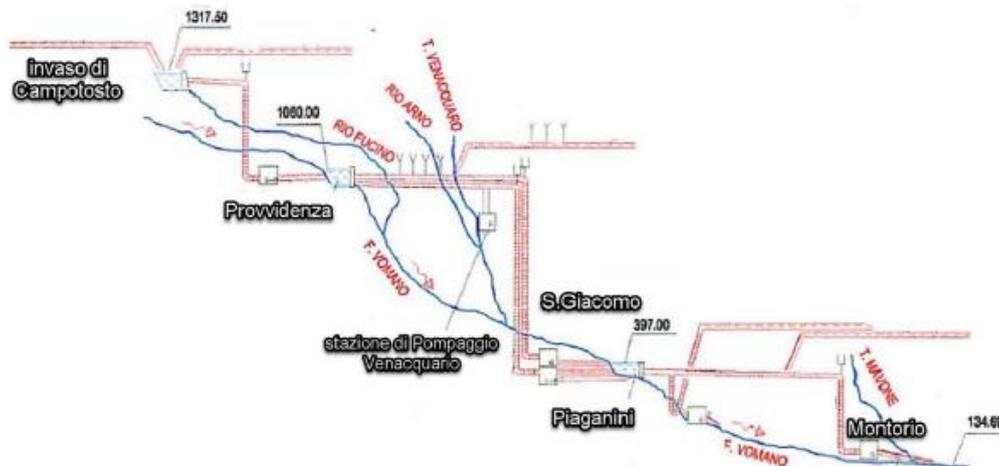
Planimetria generale e schema degli impianti dell'asta del Vomano
